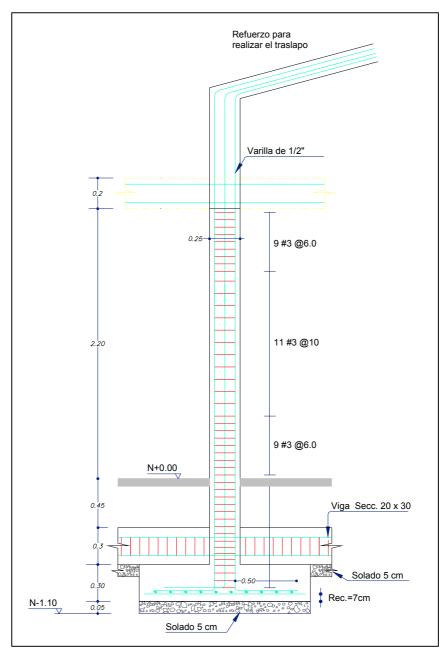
REFUERZO ESTÁNDAR DE COLUMNA
